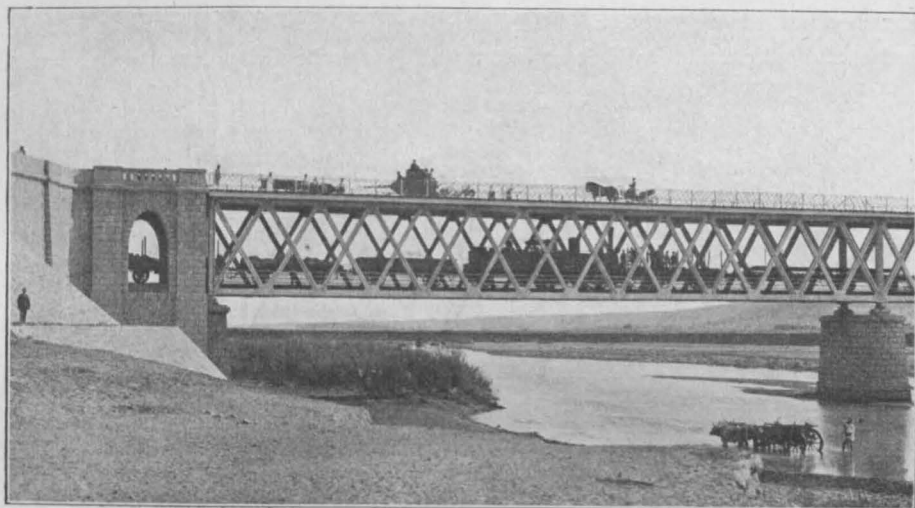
Eisenbahn- und Straßenbrücke über den Jiu bei Craiova (Rumänien). 1897.
